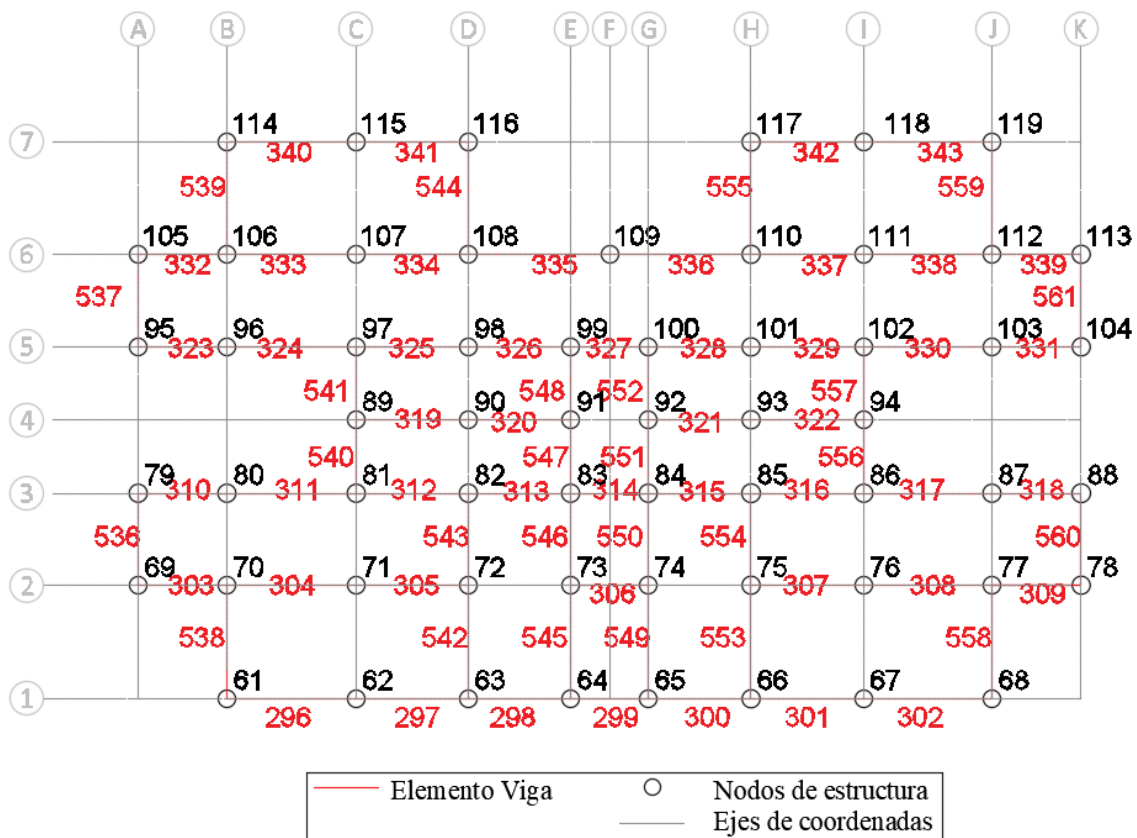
Asignación de nodos y elementos tipo viga en planta nivel 1 de modelo digital del bloque 11 de San Fernando
